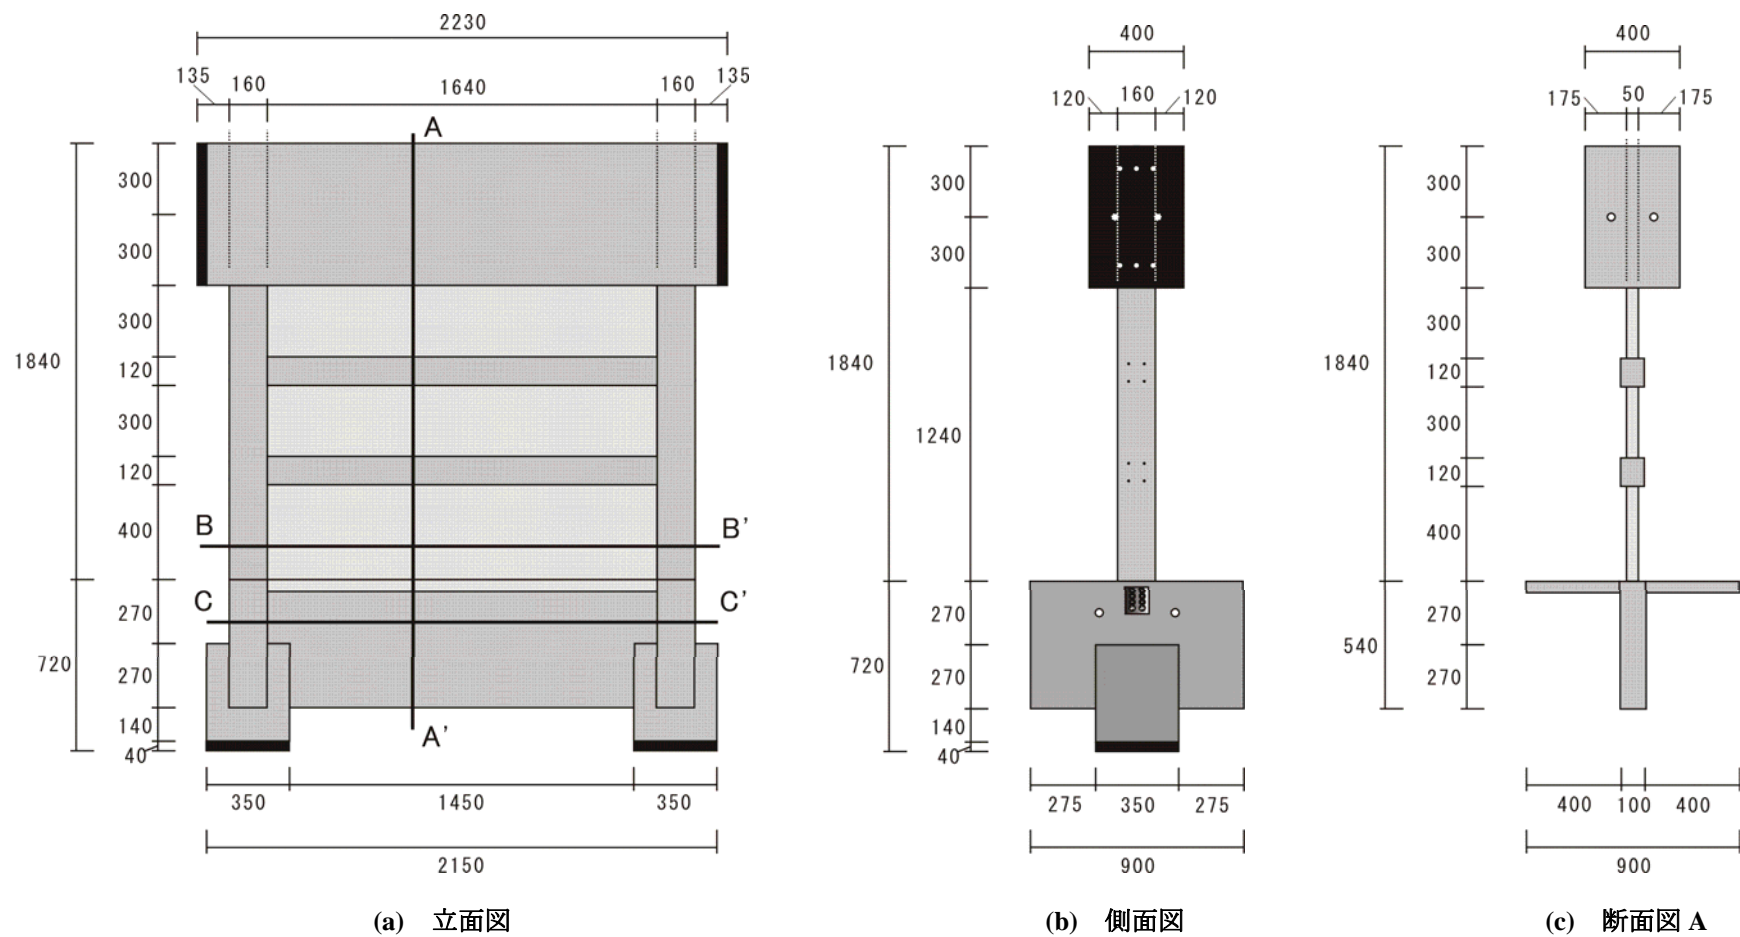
MNW 試験体の寸法 1 (単位: mm)
